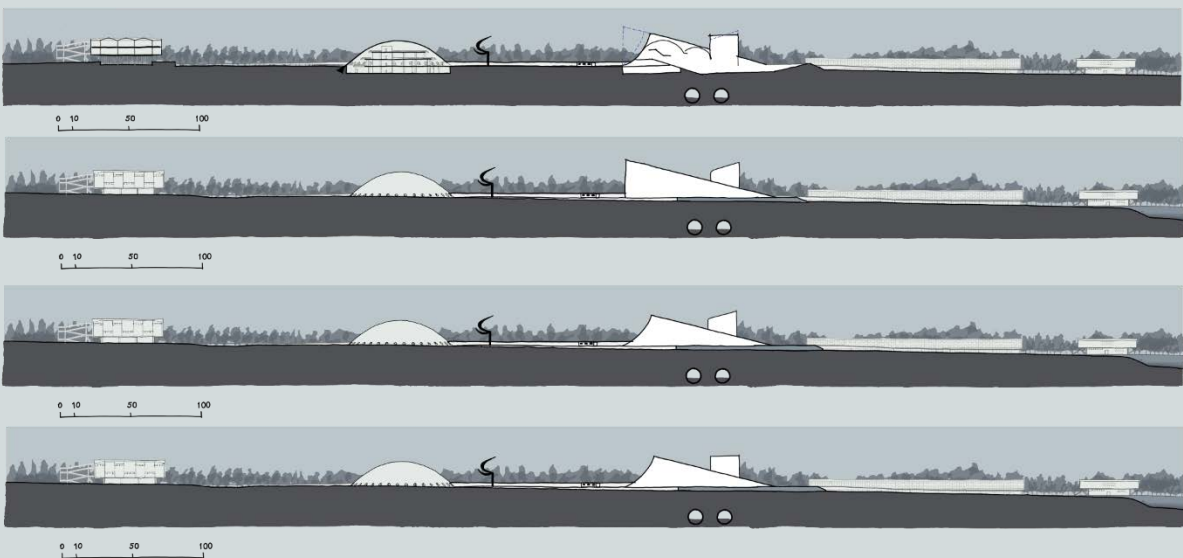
Implantação – 2000 – Versão 09 – desenho nosso.
